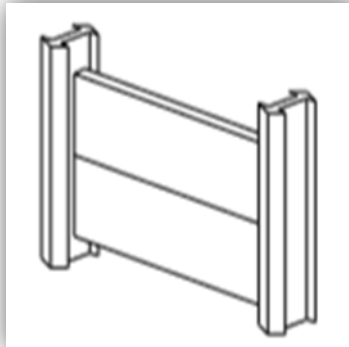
Poteaux et plaques en béton (NF EN 14475)
